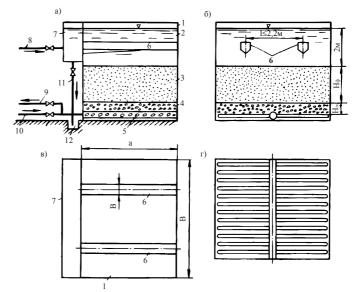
Скорый безнапорный фильтр: а-продольный разрез; б- поперечный разрез; в- вид сверху; г- дренажная система
